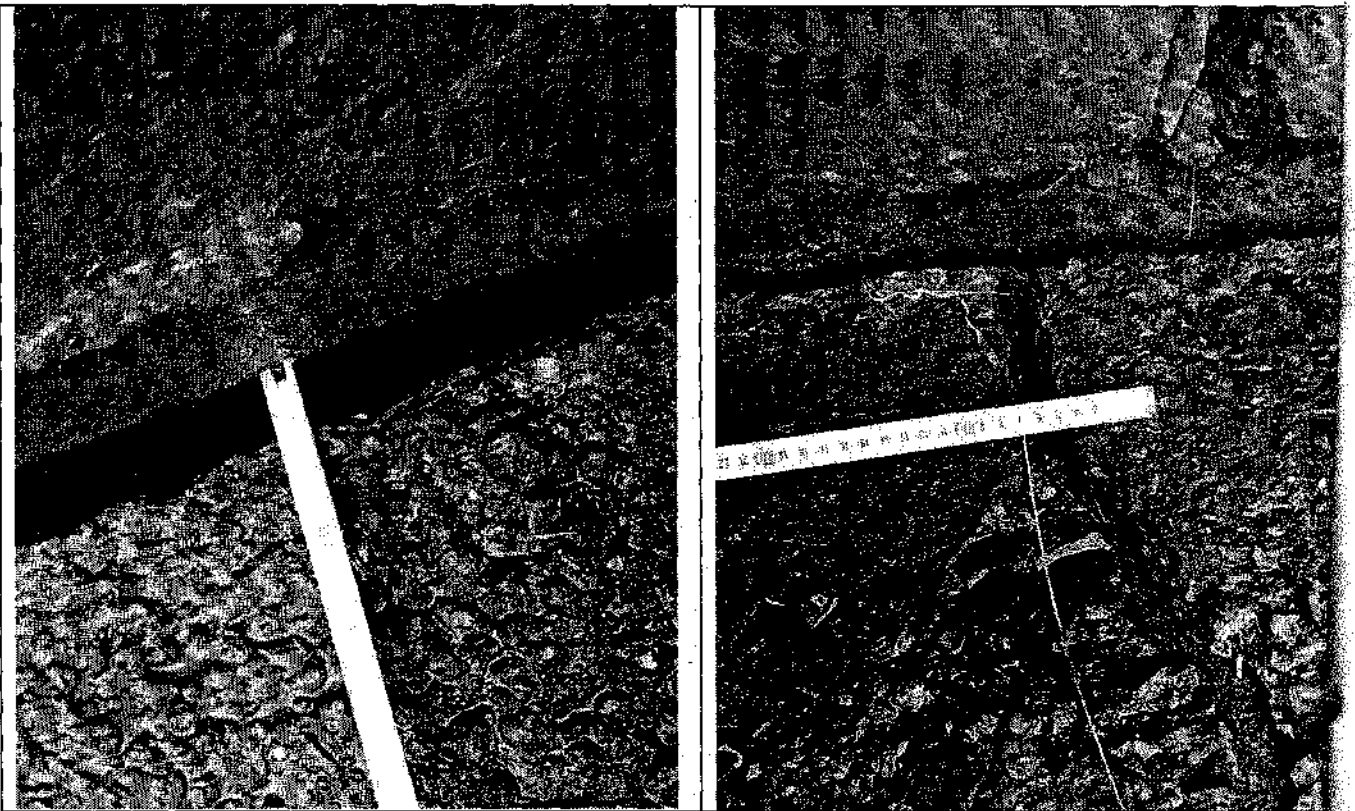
,6. Наличие трещин и локальных разрушений отмостки здания. Отхождение отмостки от стен жилого дома.
